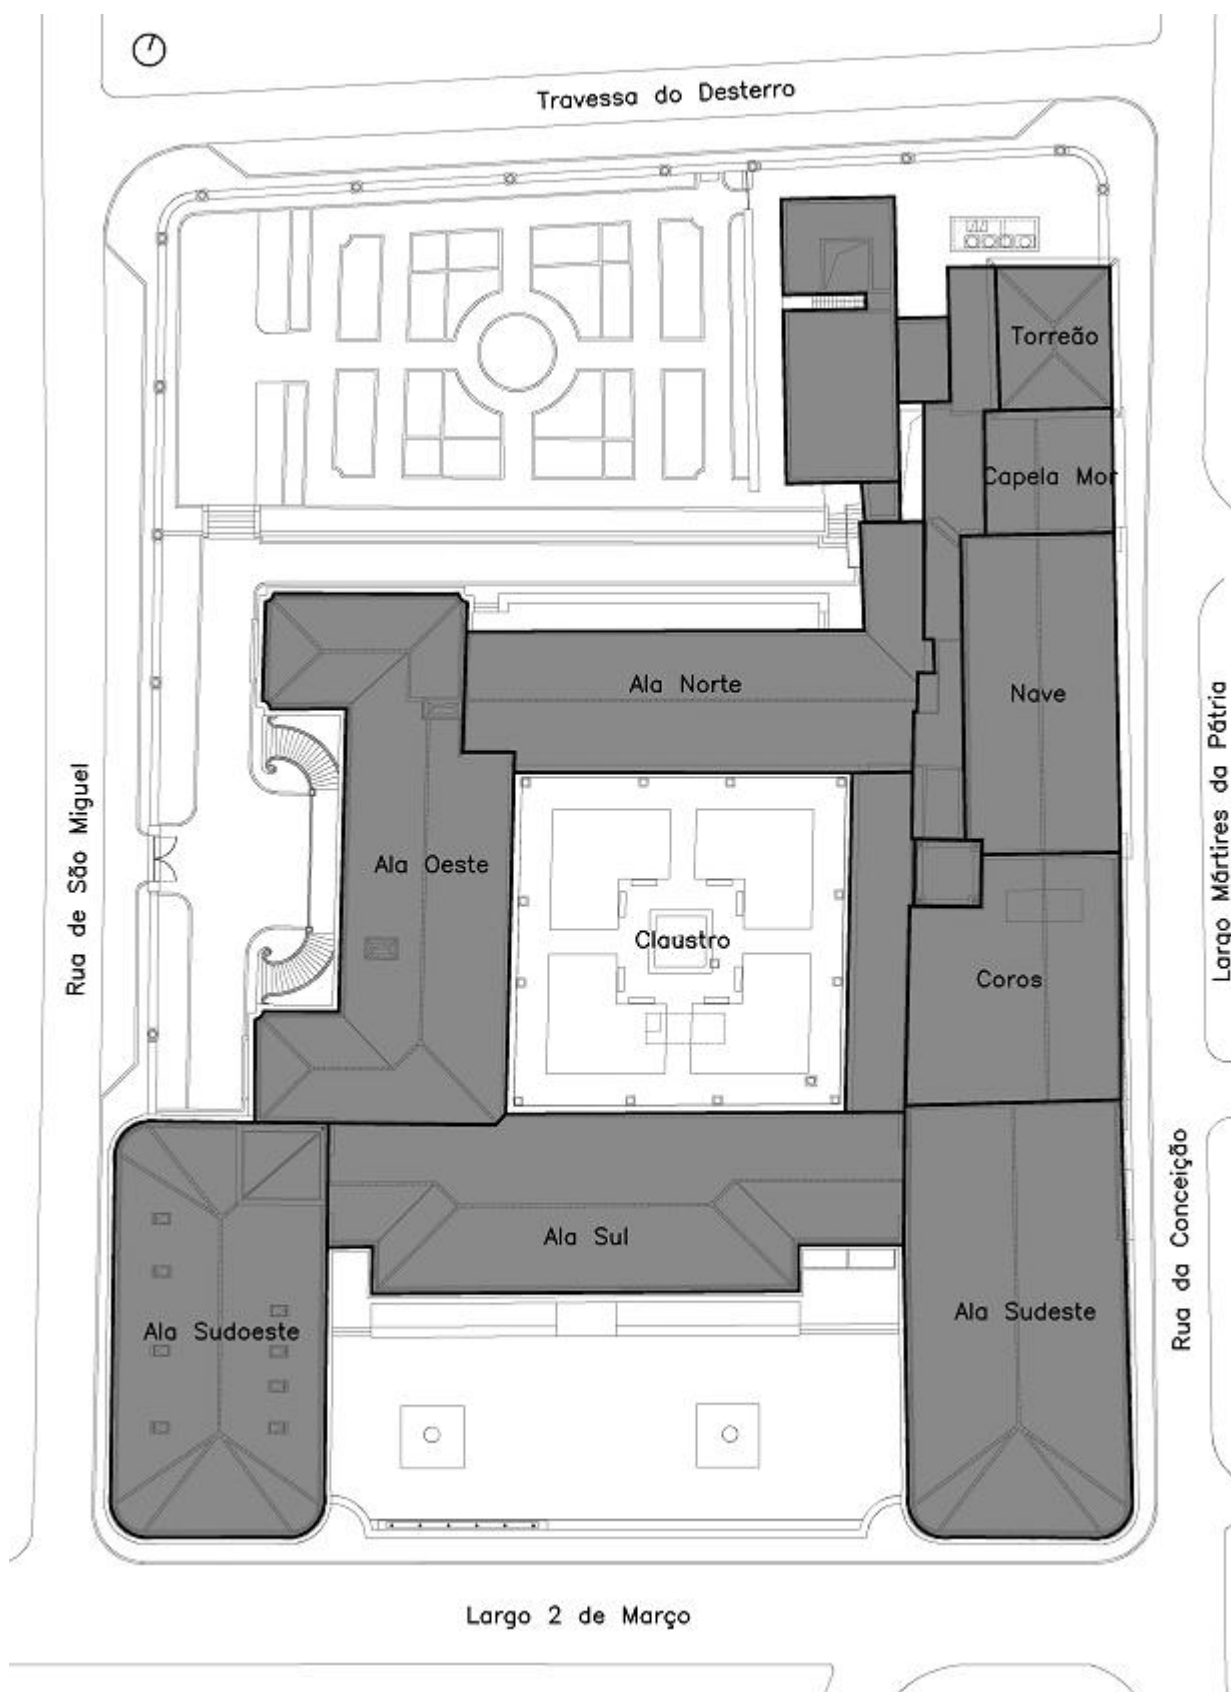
Planta com identificação dos corpos do edifício (s/ escala) desenhado sobre levantamento no anexo 27.
